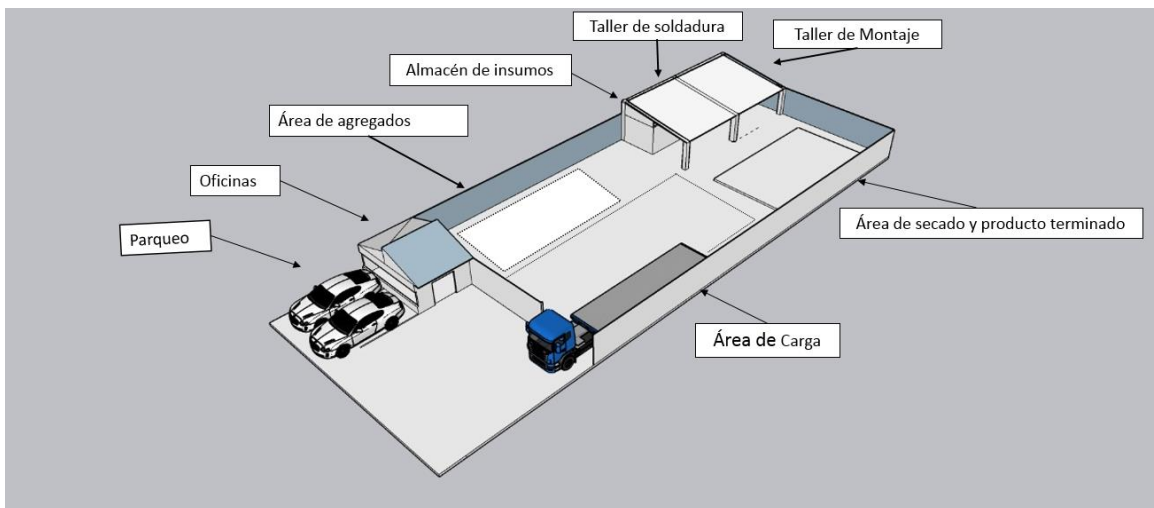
Diseño y distribución de la planta de producción de prefabricados en concreto.
